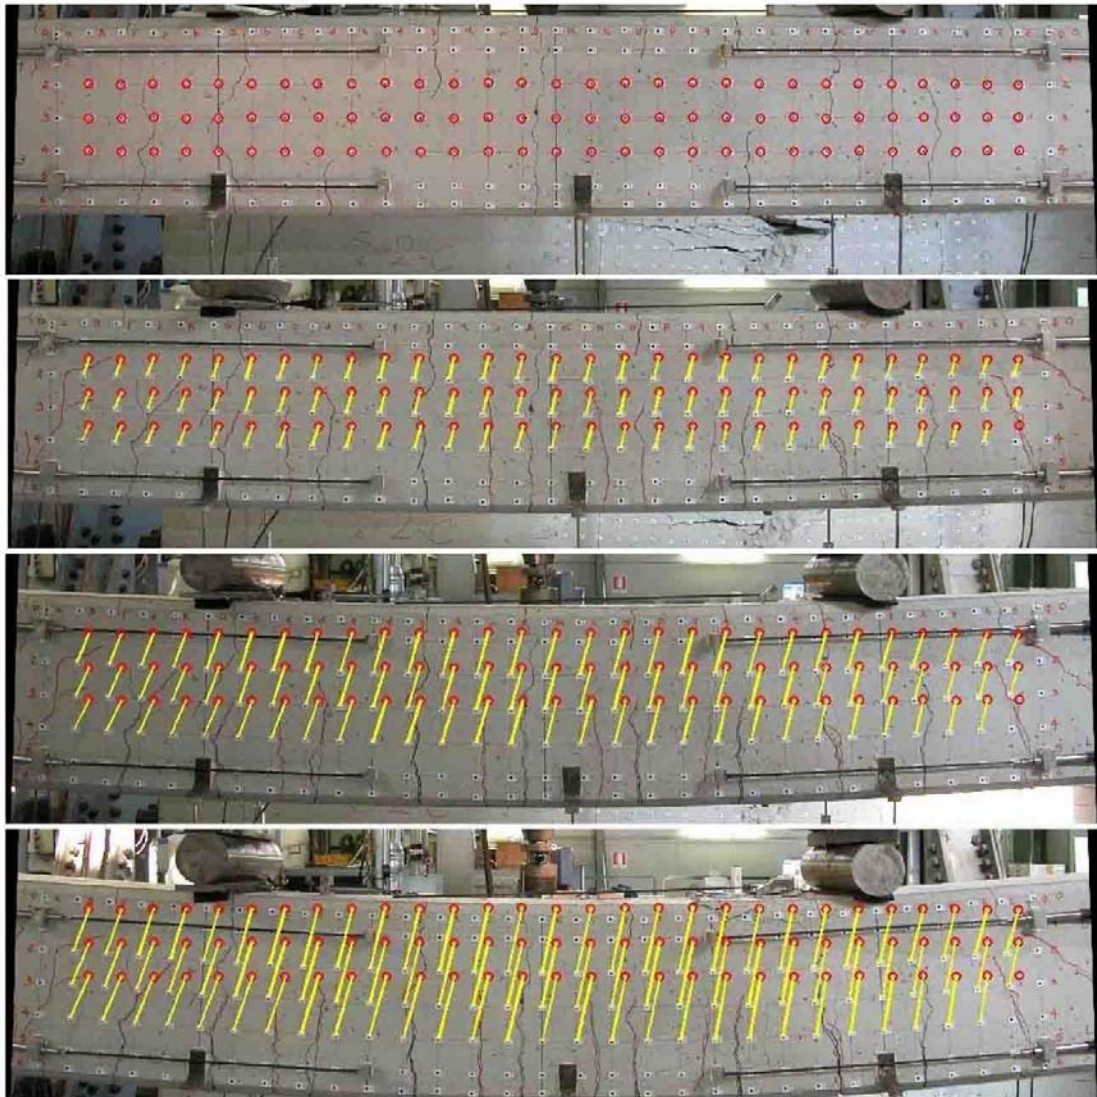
Испытание железобетонной балки на изгиб [52]
